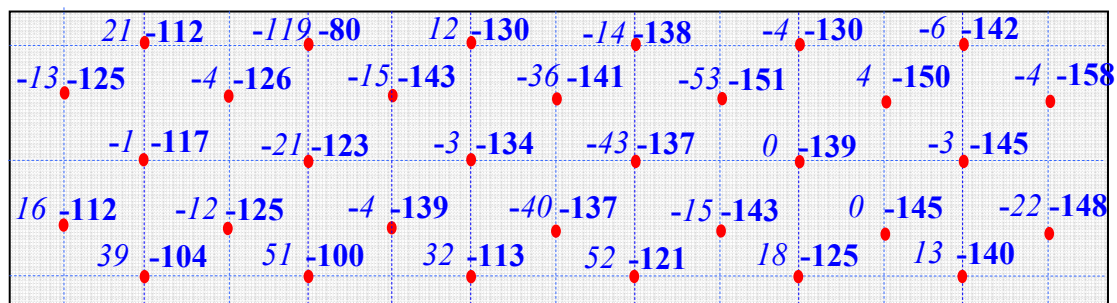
Potenciais de corrosão na face da viga V8.
